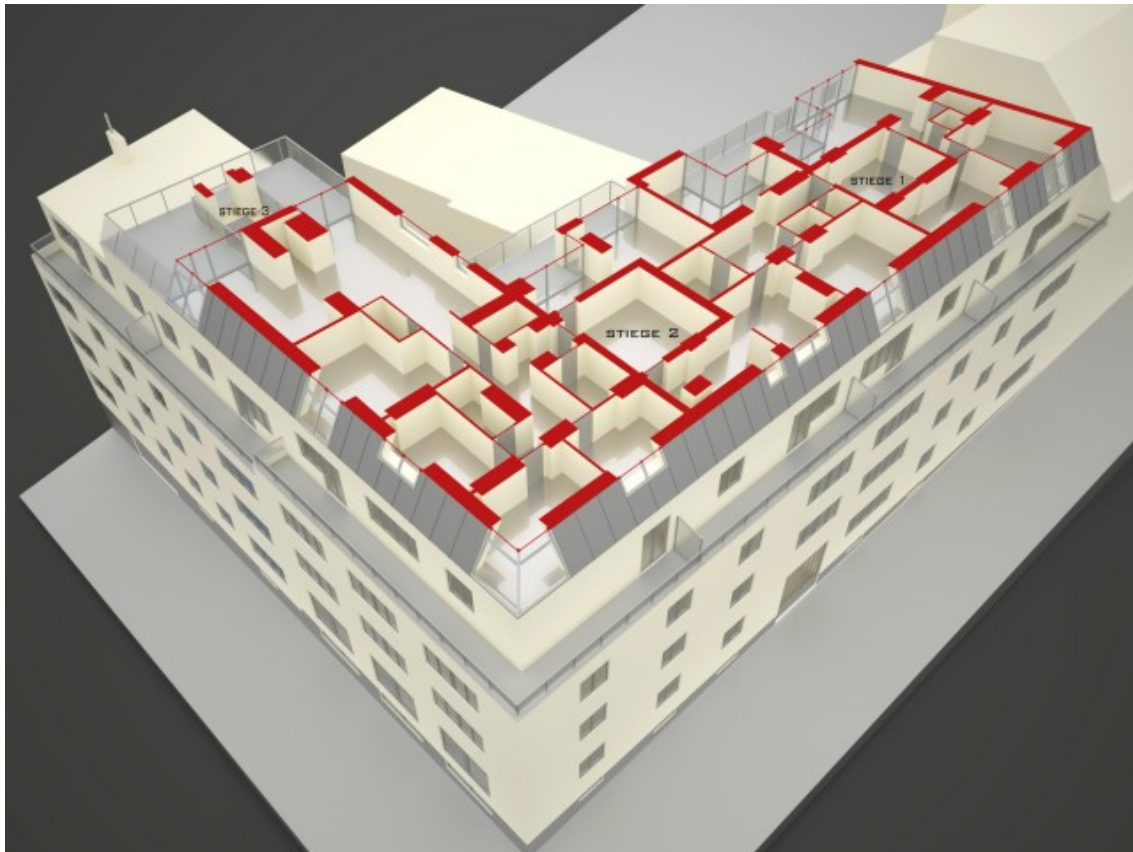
Elevación sobre edificio existente (fuente <http://www.reinberg.net/architektur/262/plane>)
